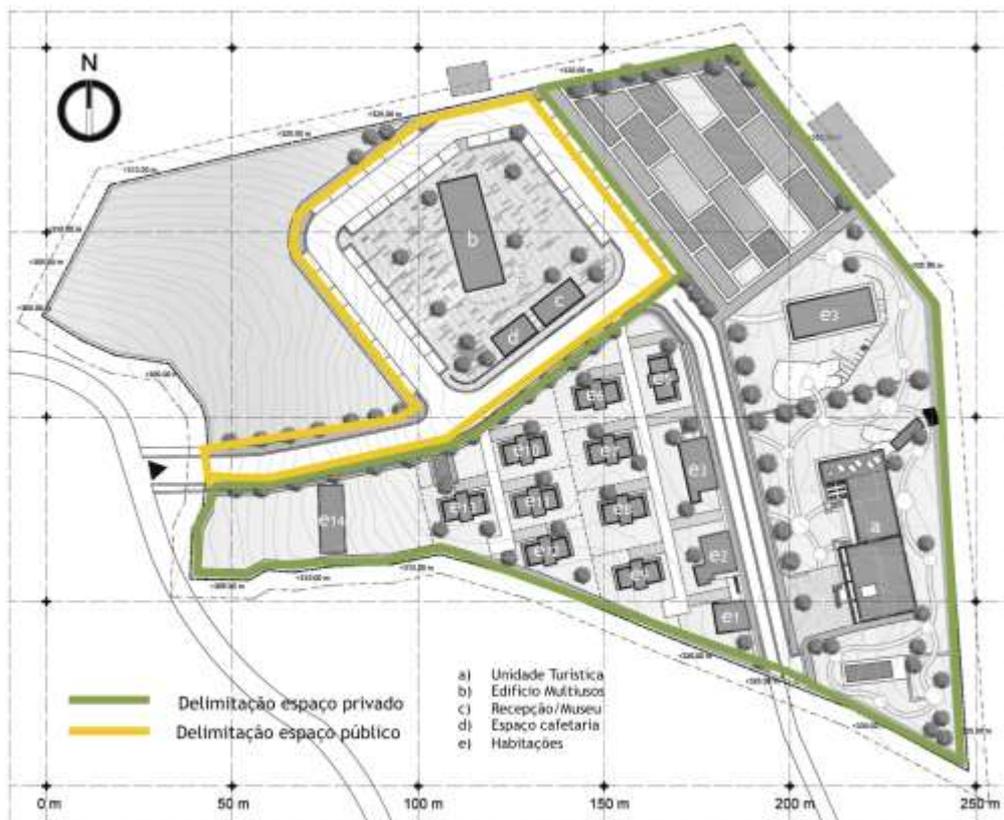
Planta com a delimitação espaço privado (a sul) e espaço público (a norte).
